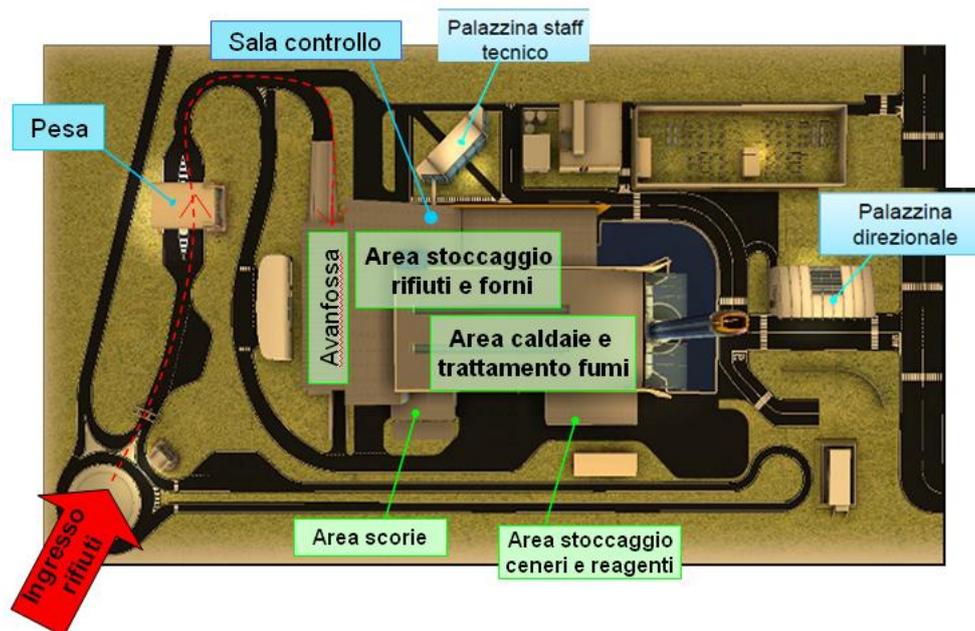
Planimetria dell'area dell'impianto con localizzazione delle aree di maggior interesse per il presente Rapporto
